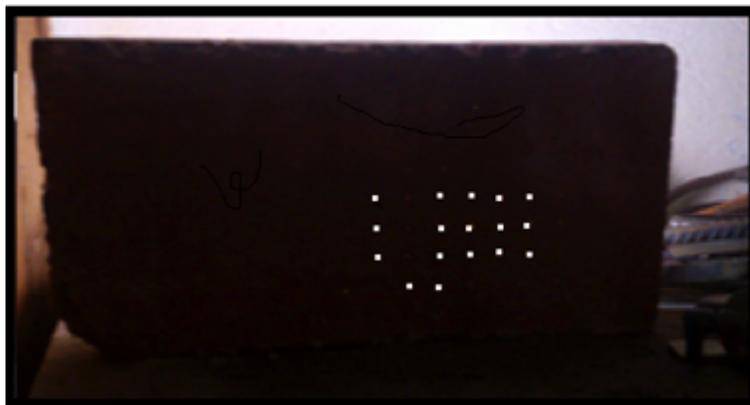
Probeta de hormigón translúcido con separación más unida.
